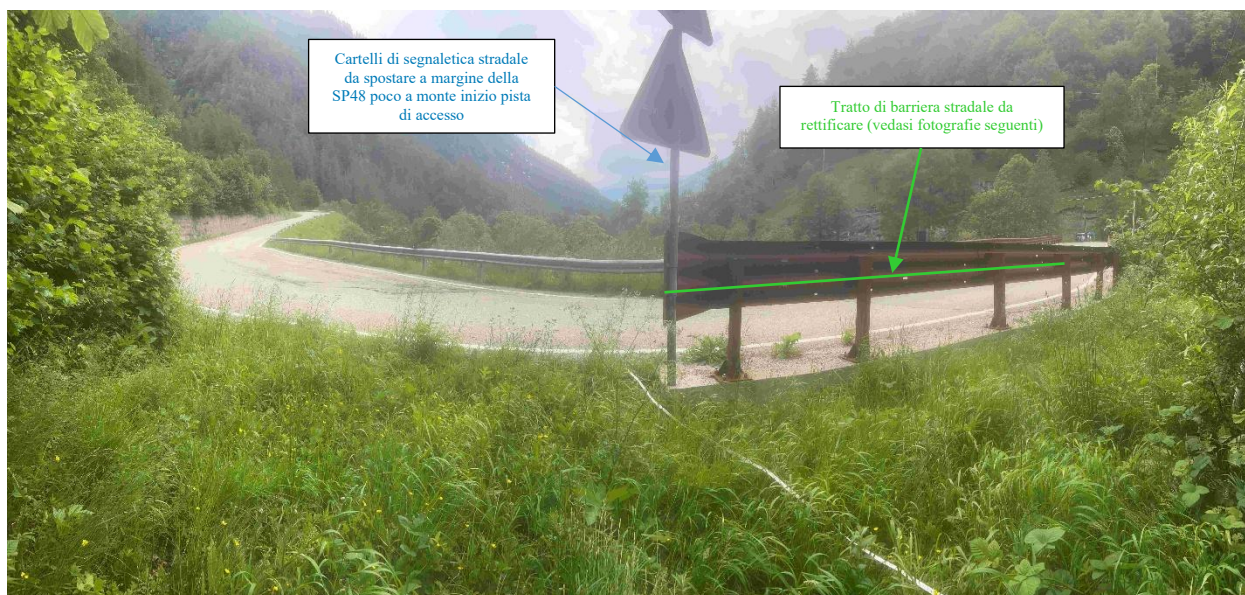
Vista attuale dal punto di intersezione della nuova pista di accesso con la S.P. 48; si noti il tratto rettilineo in direzione Piamprato; in direzione Valprato risulta necessaria la modifica dell'andamento della barriera stradale a partire dal quarto sostegno (vedasi immagini fotografiche seguenti)
